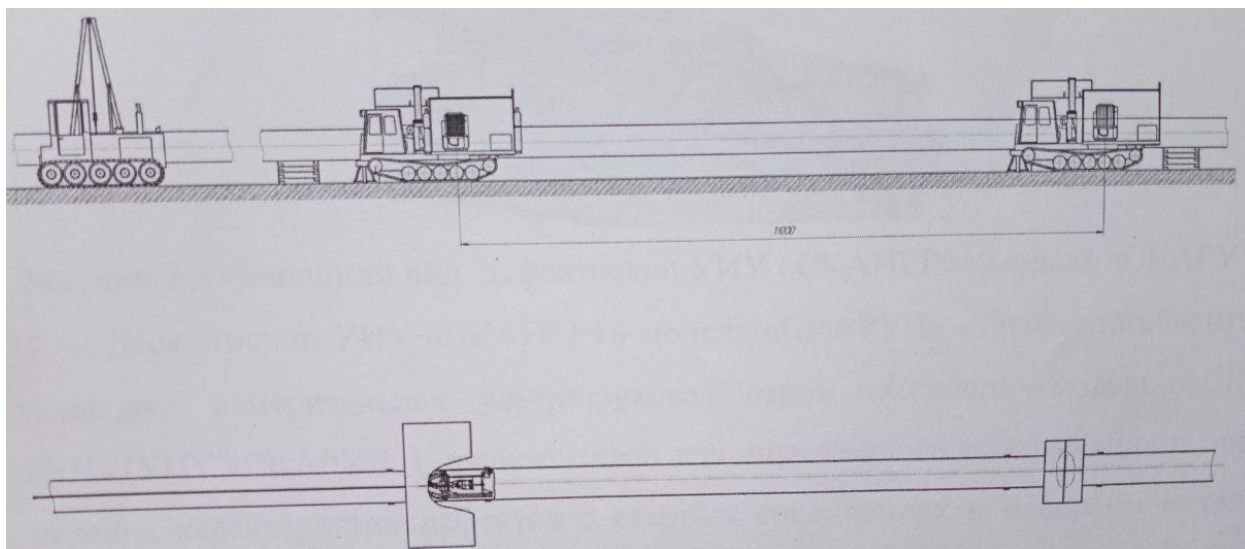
Поточно-расчлененный метод сборки и сварки
